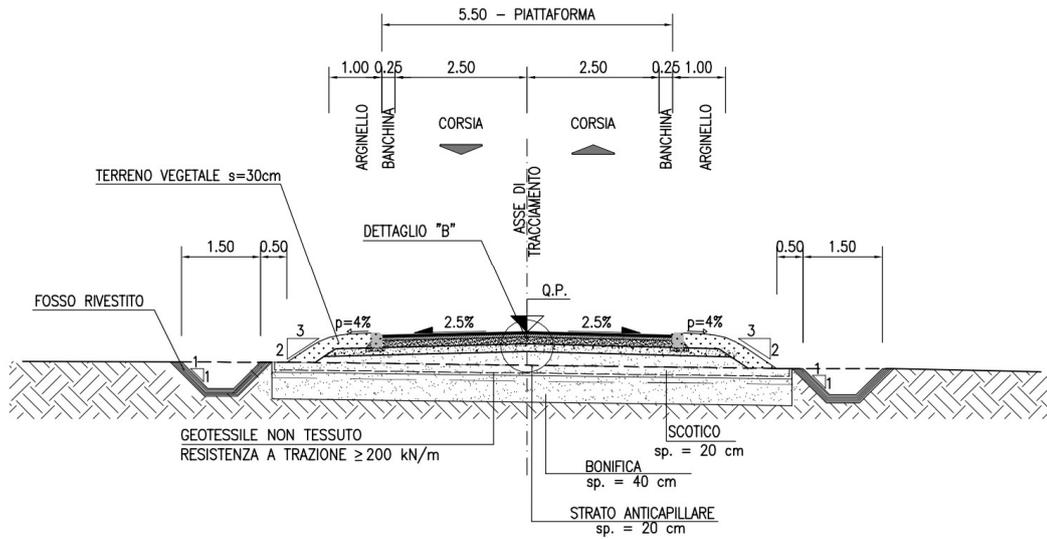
Sezione tipo RAMO 3 (Strada Comunale di accesso)
